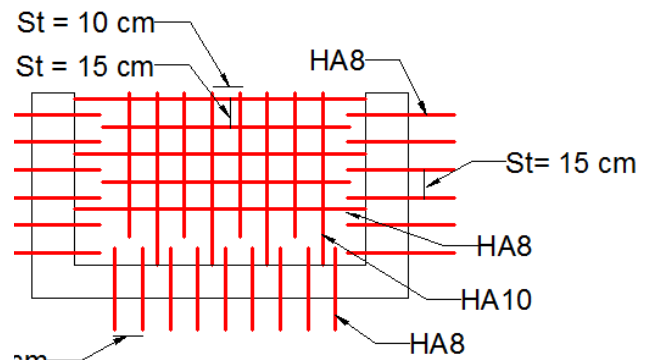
Ferrailage de la dalle sur 3 appuis.
